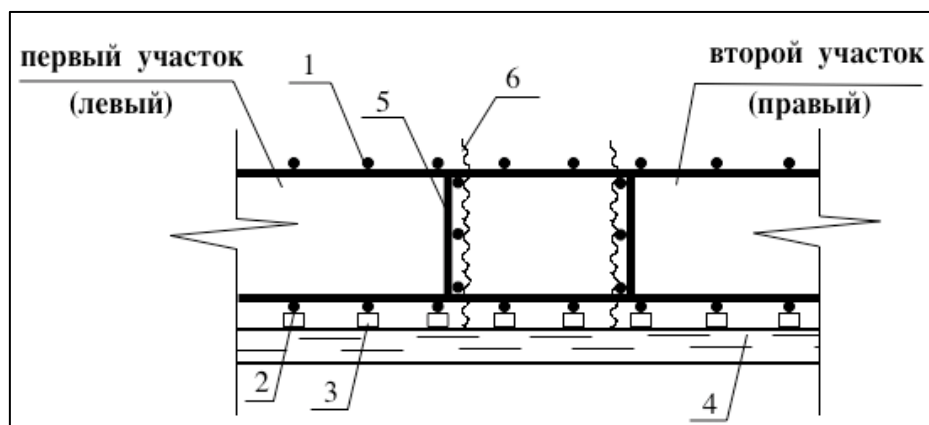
Установка плоских арматурных каркасов и металлической сетки на участках: 1 – верхняя арматура, 2 – нижняя арматура, 3 – пластмассовые фиксаторы, 4 – опалубка; 5 – плоский поддерживающий каркас, 6 – металлическая сетка
